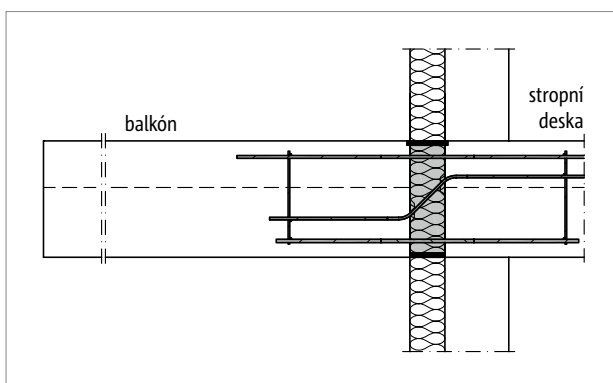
Schöck Isokorb® XT typ BP: Balkónová konstrukce s volně vyloženými průvlaky (prefabrikovaný balkón)
